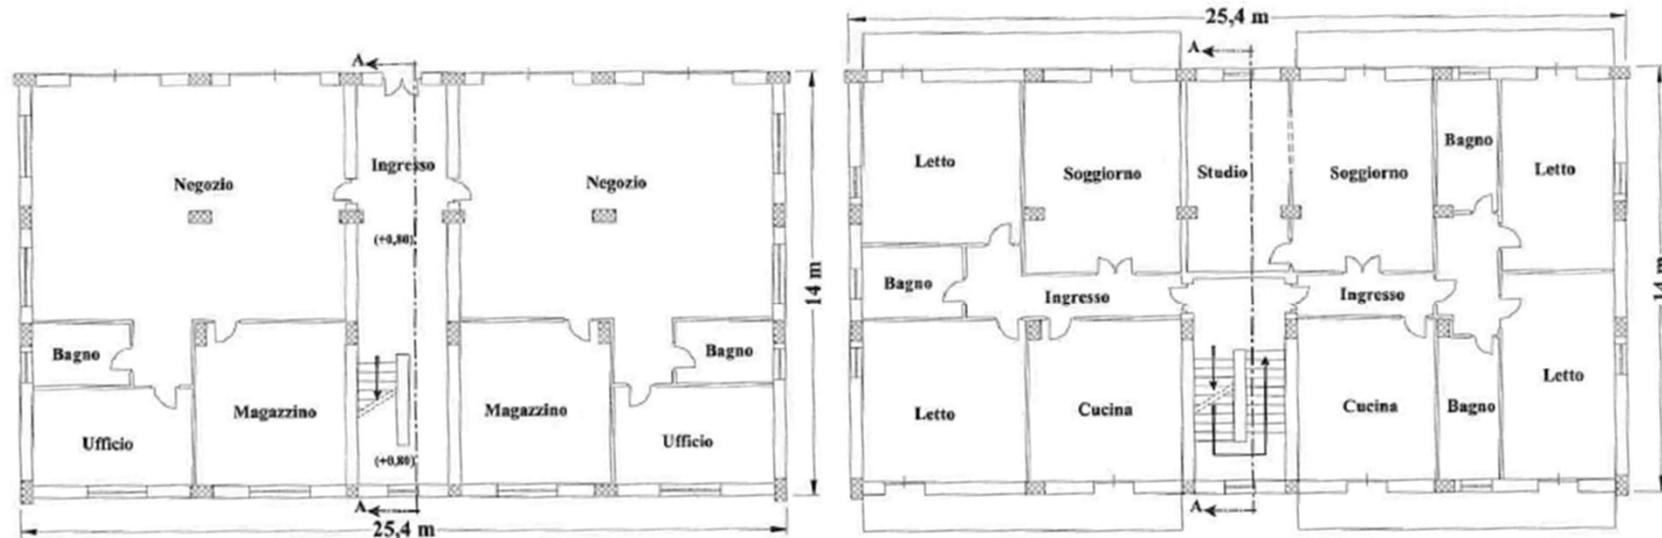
Pianta piano tipo (sx) e primo piano (dx)
